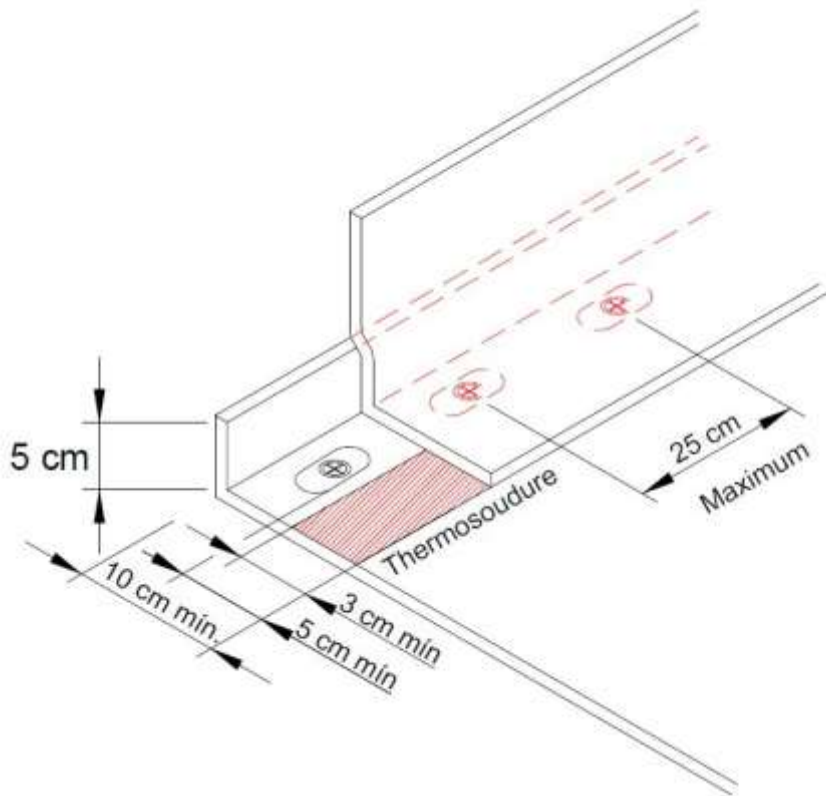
B - Fixation en pied de relevé par vis et plaquettes
